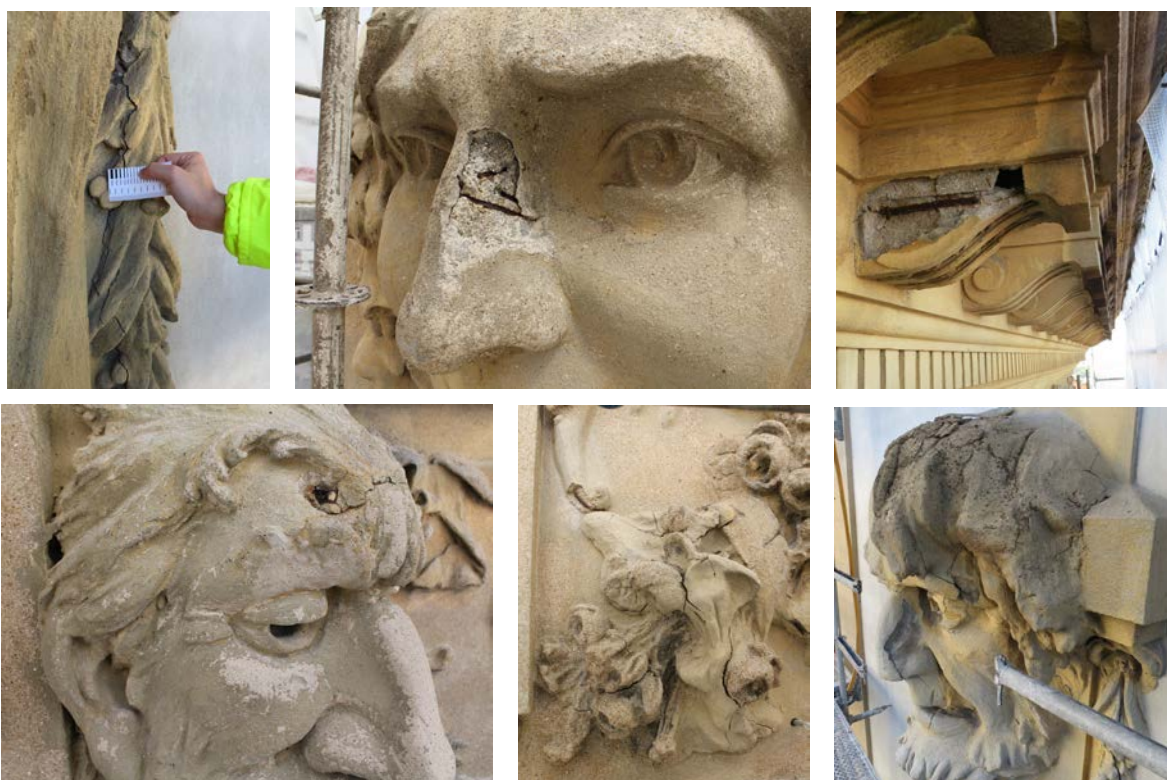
Fachadas e elementos escultóricos e decorativos em betão armado do Teatro Nacional de São João
